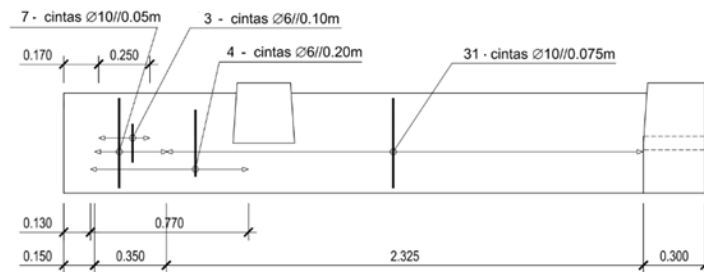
Armadura transversal dimensionada para o elemento B do modelo S4 com ligações parafusadas.
